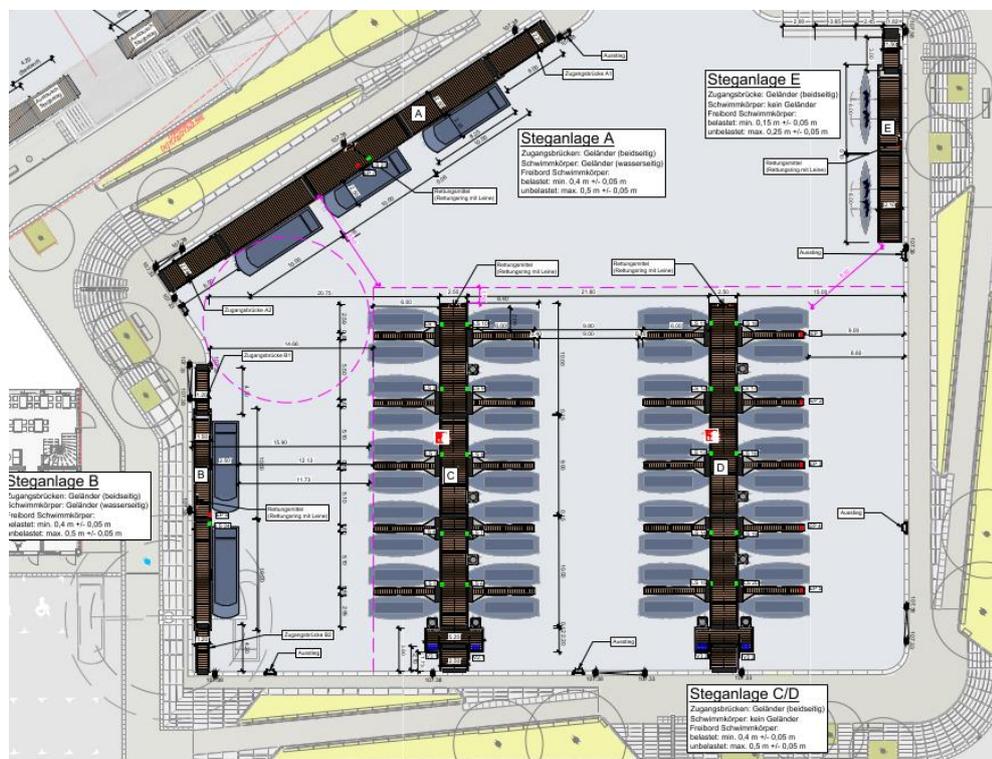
Übersichtslageplan Stadthafen und Steganlagen (Auszug Anlage 2: AnL2.1, B5.1.1-Lageplan\_Steganlagen)
